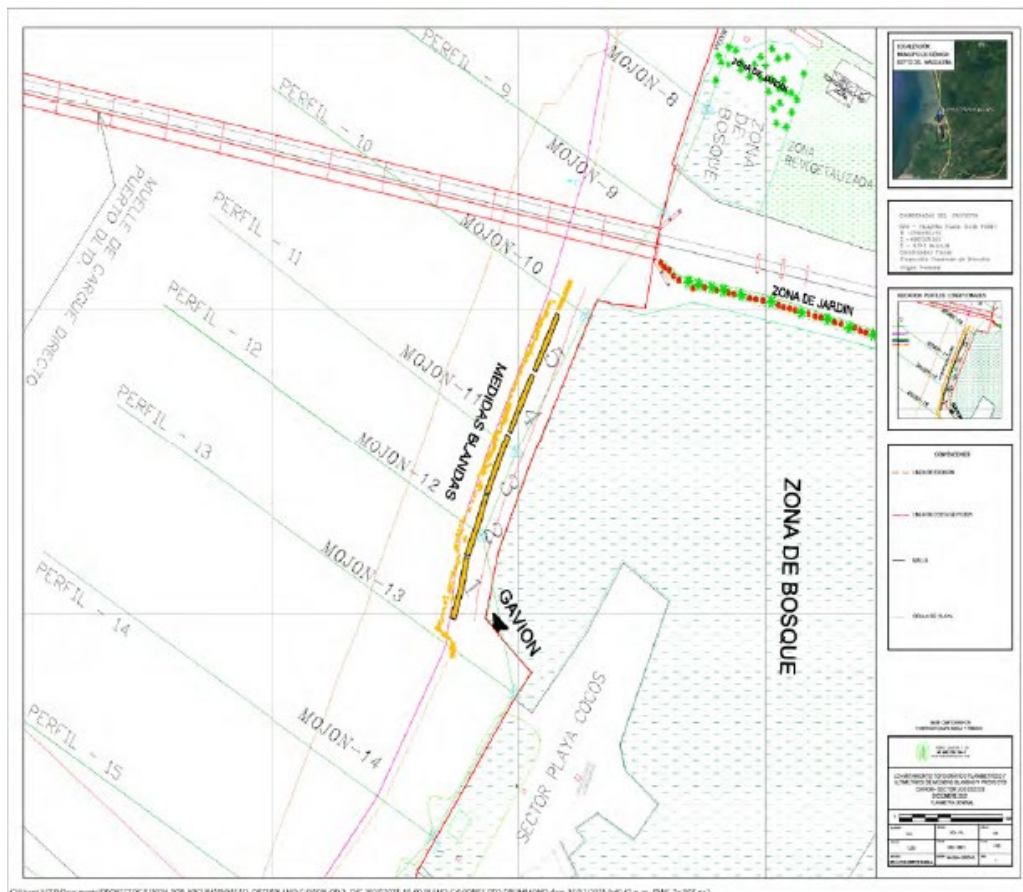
Planimetría de la Zona de Ubicación del Sistema Tipo Gavión
